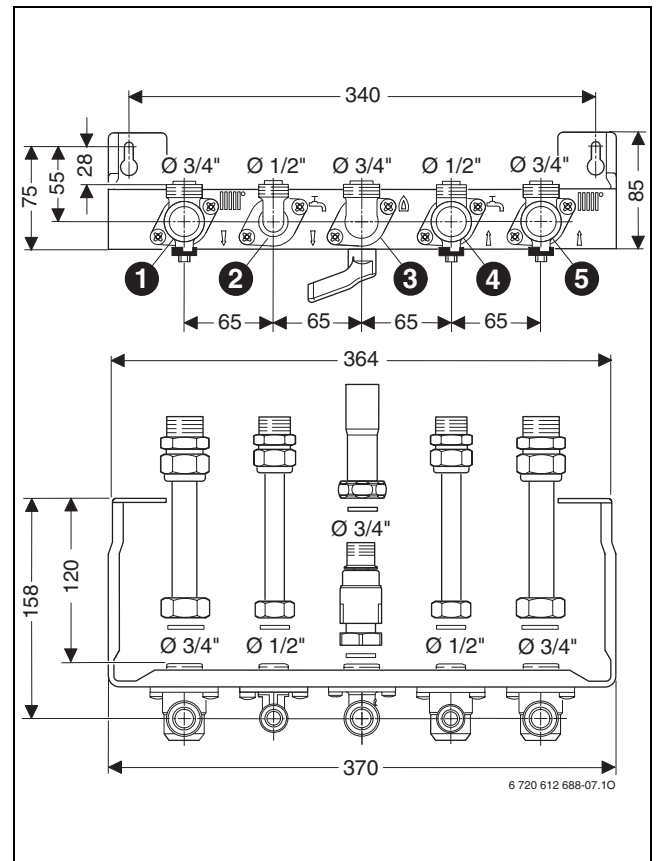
Piastra di collegamento per il montaggio orizzontale
